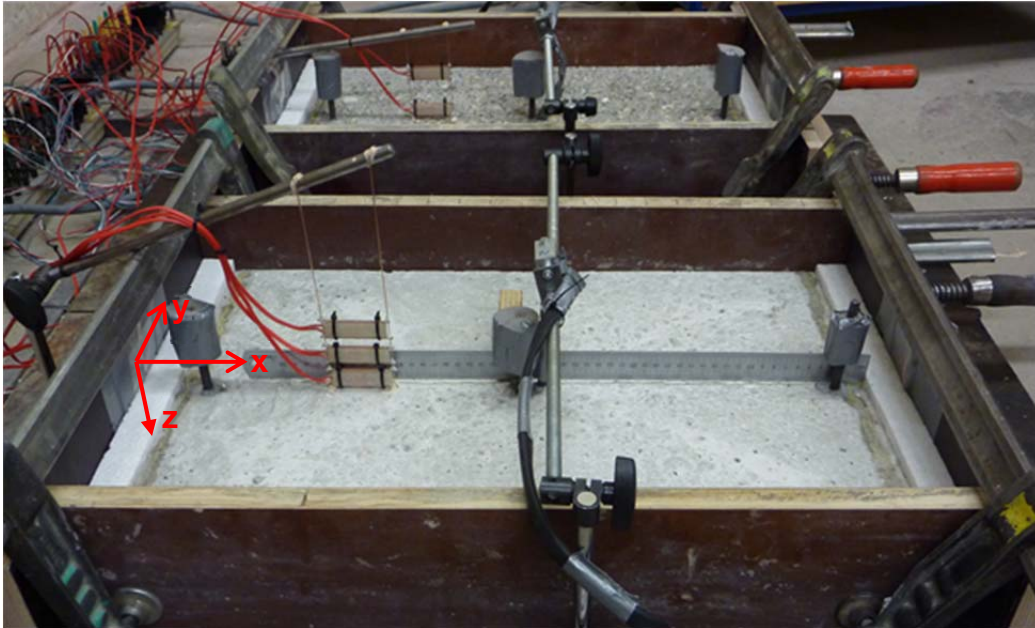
Altbetonplatten mit Stab-DMS und Betondehnmessstreifen vor Ergänzung
